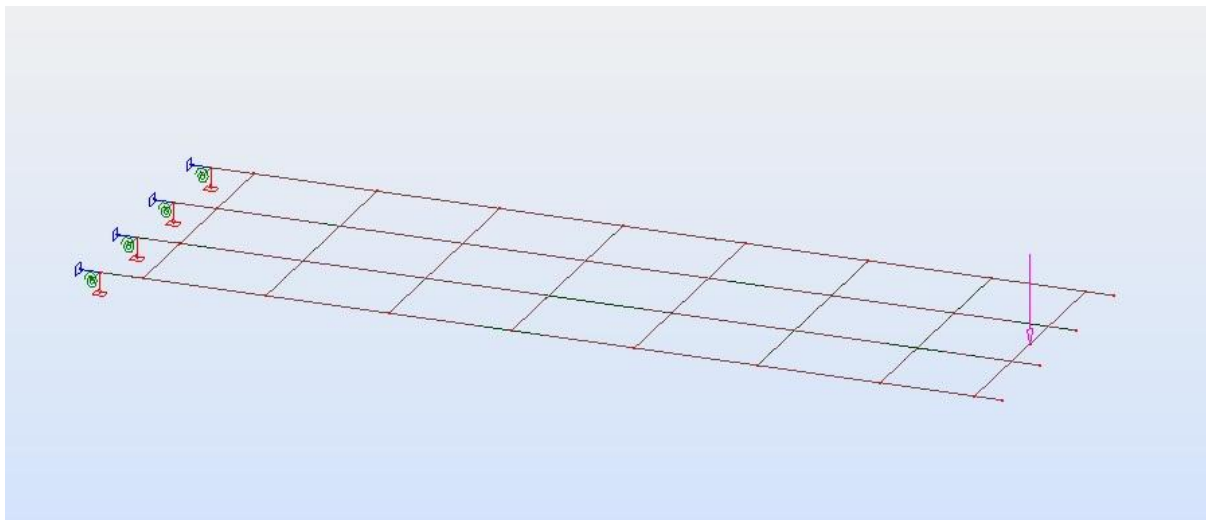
Modelo de barras, no Robot, do provete submetido ao ensaio.
